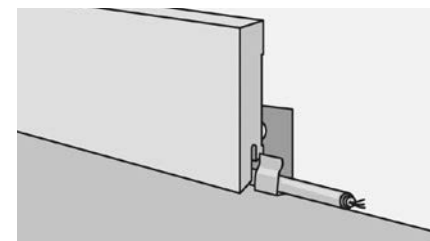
После укладки пола нужно вынуть фиксирующие клинья, а расширительные зазоры закрыть декоративным плинтусом. Плинтус крепится только к стене. Не допускается крепление плинтуса к напольному покрытию. Рекомендуем использовать для крепления специальные клипсы для плинтуса.
